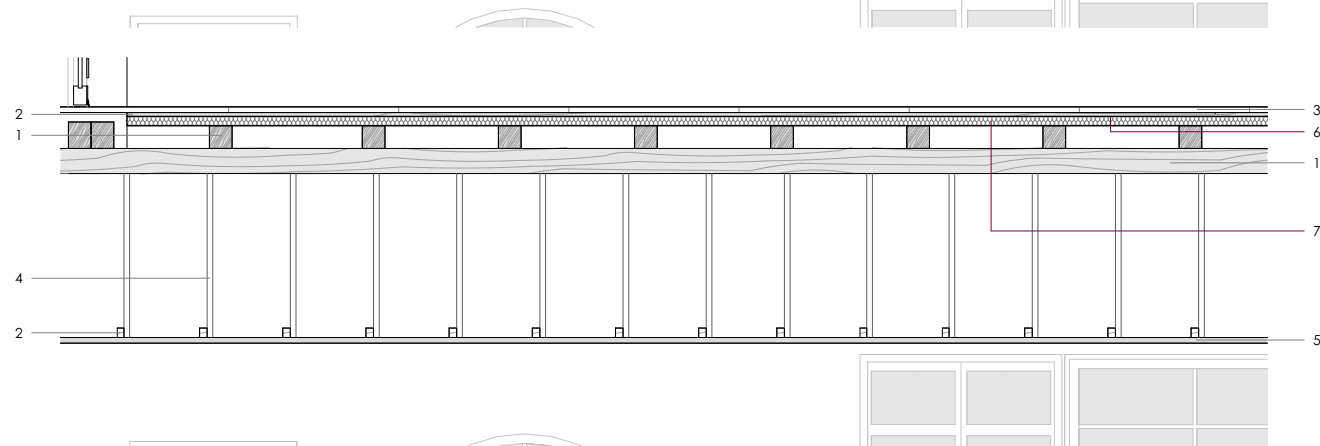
Detalle constructivo 32 | Propuesta aislamiento entrepiso, espacio: dormitorio.
